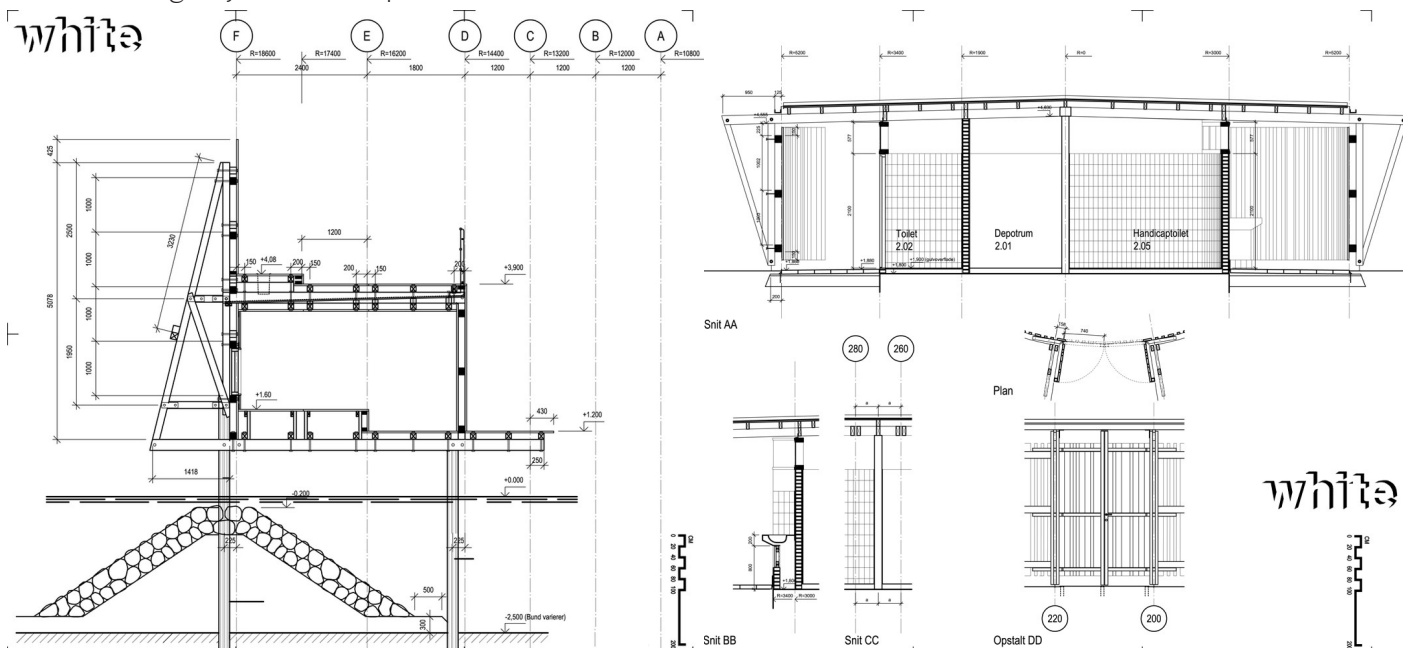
Sección constructiva de dos niveles del pabellón marítimo. Destacan los elementos de soporte exteriores.
